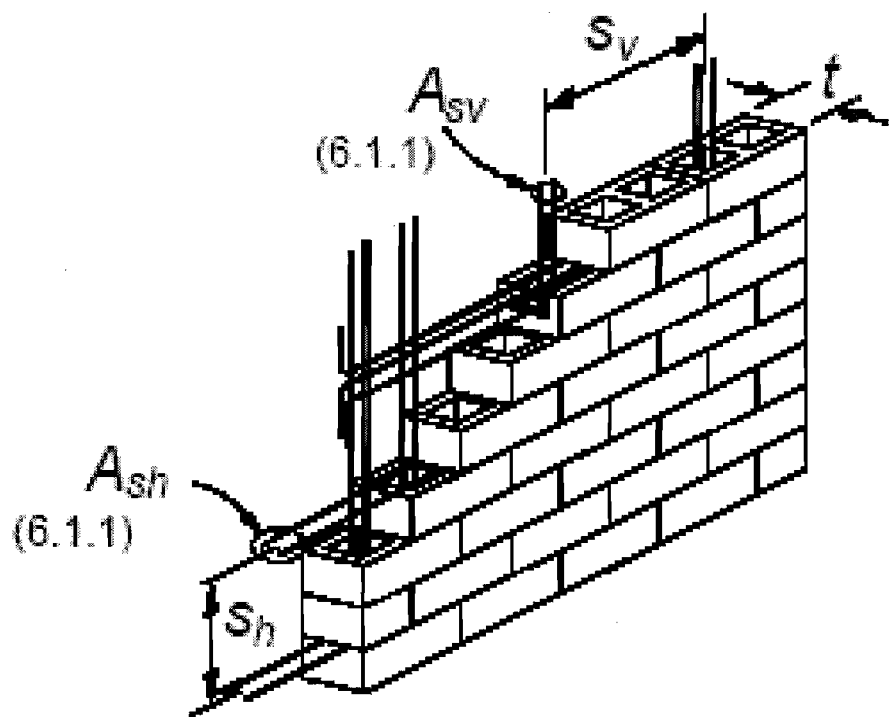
Requisitos para mampostería con refuerzo interior.
